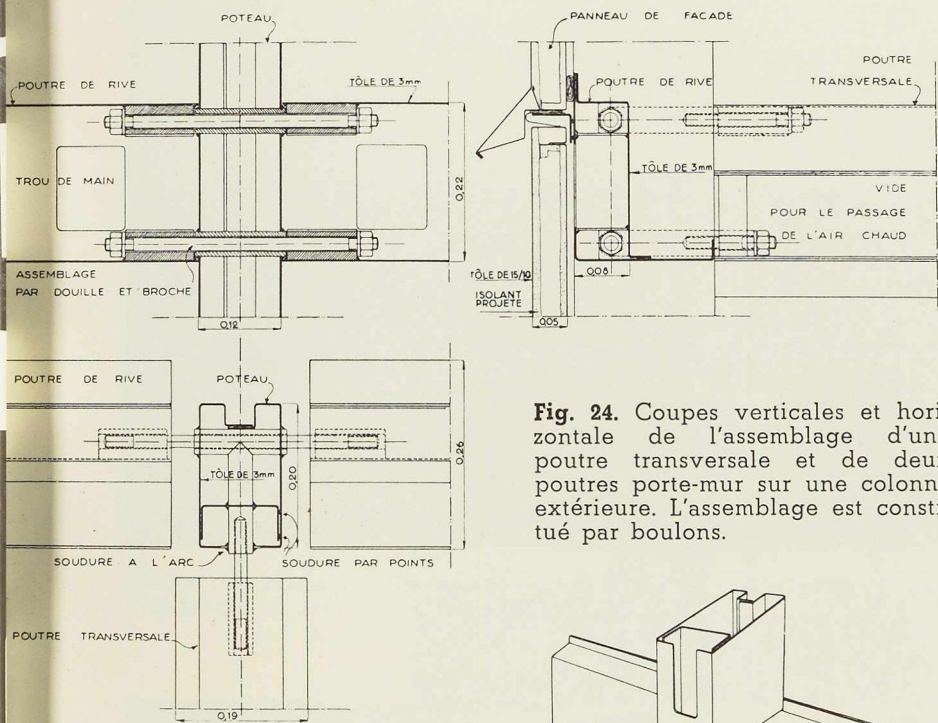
Coupes verticales et horizontale de l'assemblage d'une poutre transversale et de deux poutres porte-mur sur une colonne extérieure. L'assemblage est constitué par boulons.
